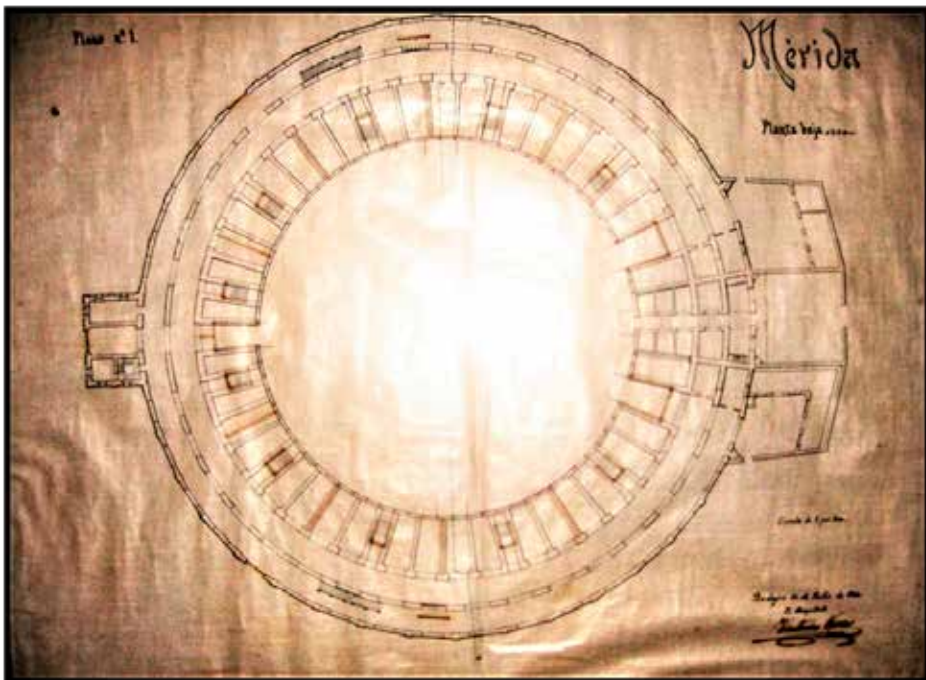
Plano de la planta baja de la plaza de toros. Fuente: AFFVM.
